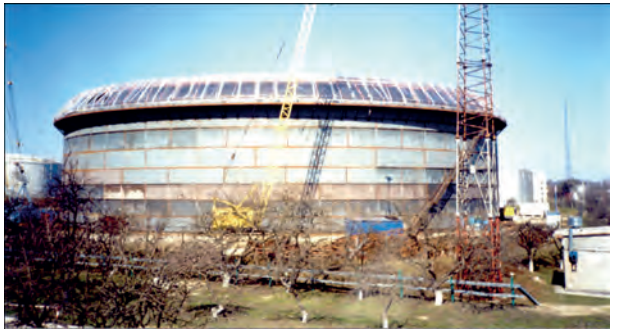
Резервуар для зберігання нафти місткістю 75000 м³ із сталевого прокату 06Г2Б-440
